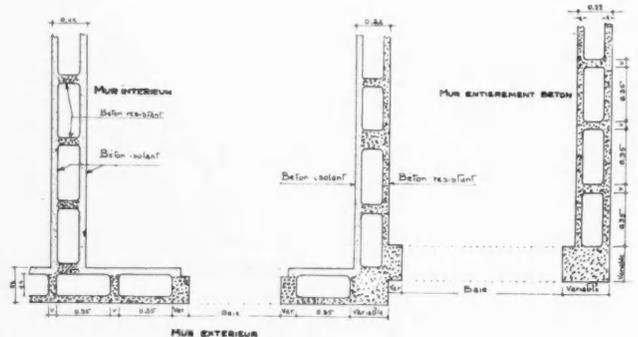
Fig. C. Plan de murs réalisés par le système photographié ci-contre montrant la nature des parois suivant la nécessité d'isolation.
